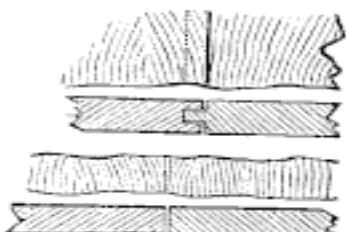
Vue latérale de deux planches assemblées à rainures et languettes.
